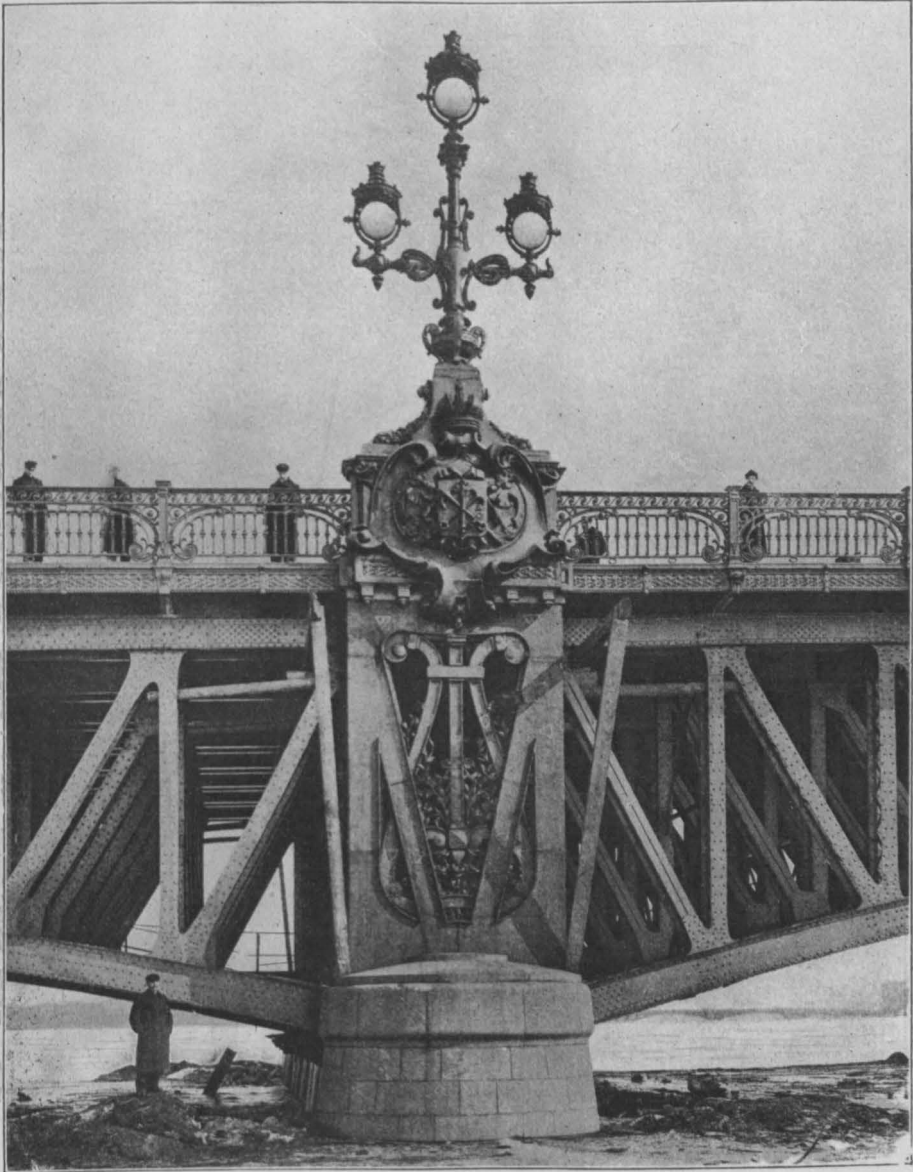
Mittelpfeiler der Troitzkybrücke (Fig. 915.)
